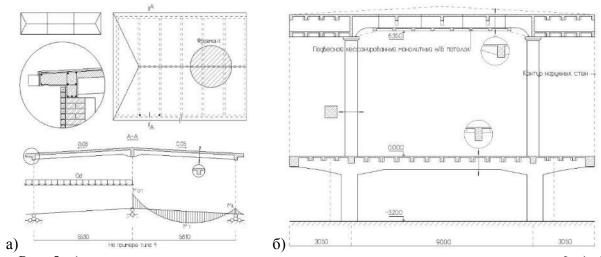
а) — конструкция покрытия многоквартирного жилого дома, пролет до 6 м), б) — зрительного зала здания Клуба (бывш. Дома офицеров), пролет 9 м, консольный участок ок. $3 \, \mathrm{m}$
